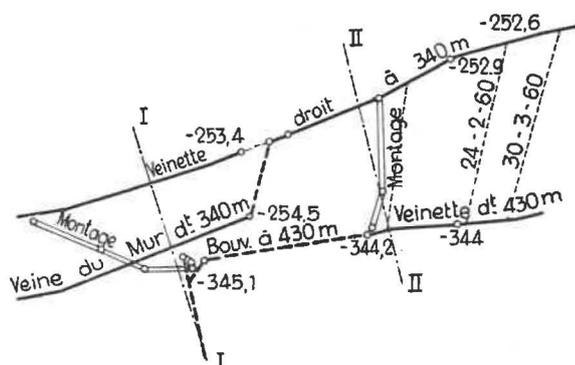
Plan du chantier et coupe par les méridiens I et II.
